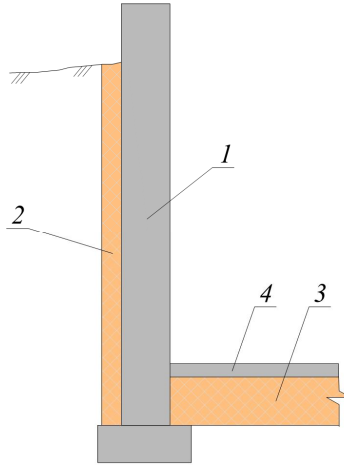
Утепление узла сопряжения пола по грунту и стены с наружным слоем тепловой изоляции: 1 – ж/б стена; 2, 3 – пенополистирол; 4 – цементно-песчаная стяжка
